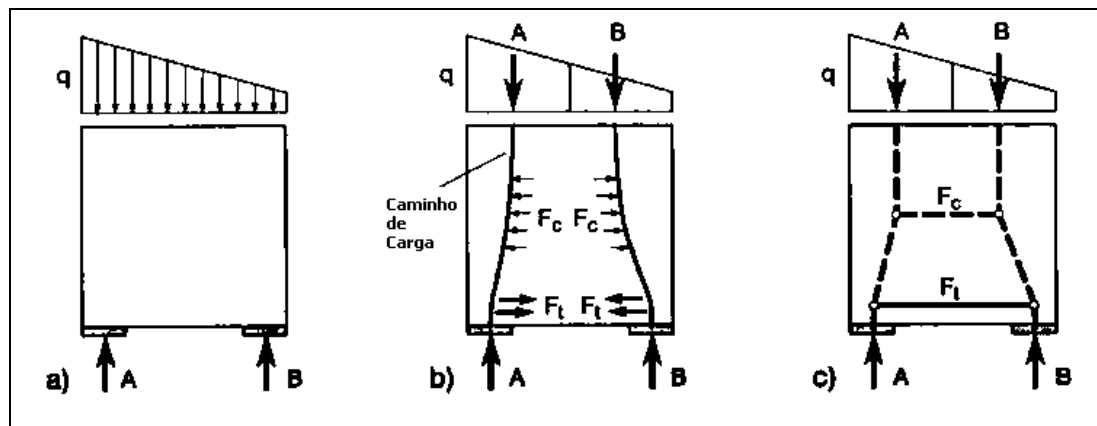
Aplicação do caminho de carga em uma viga-parede
